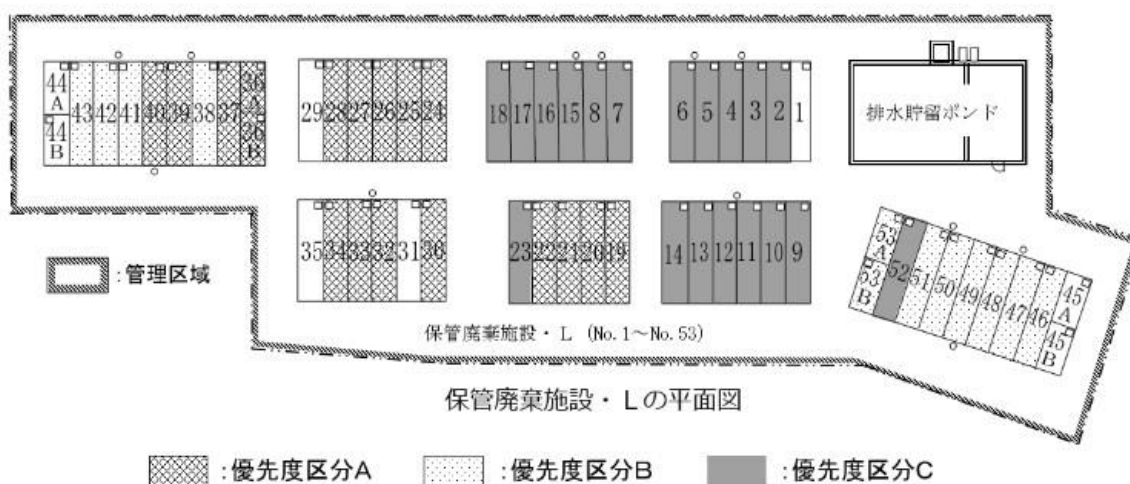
保管廃棄施設・Lの全体配置図
